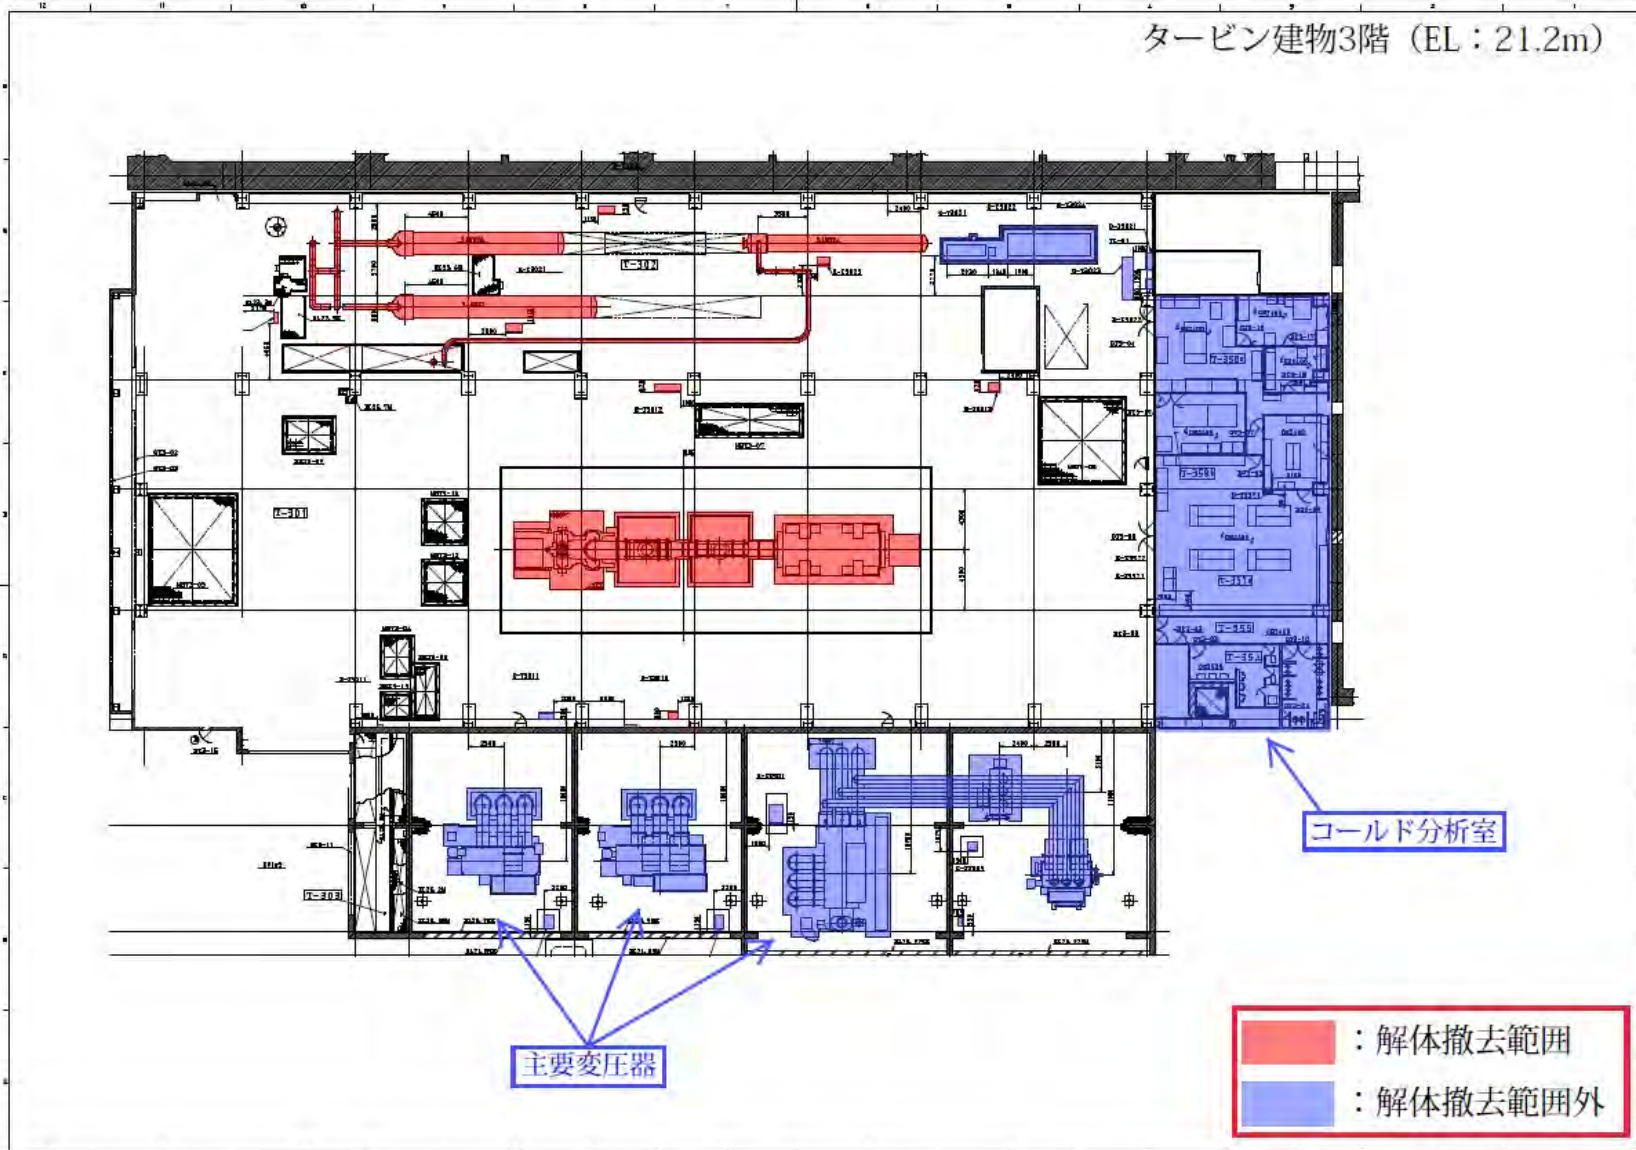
主な解体撤去機器 (タービン建物平面図) (4/7)
